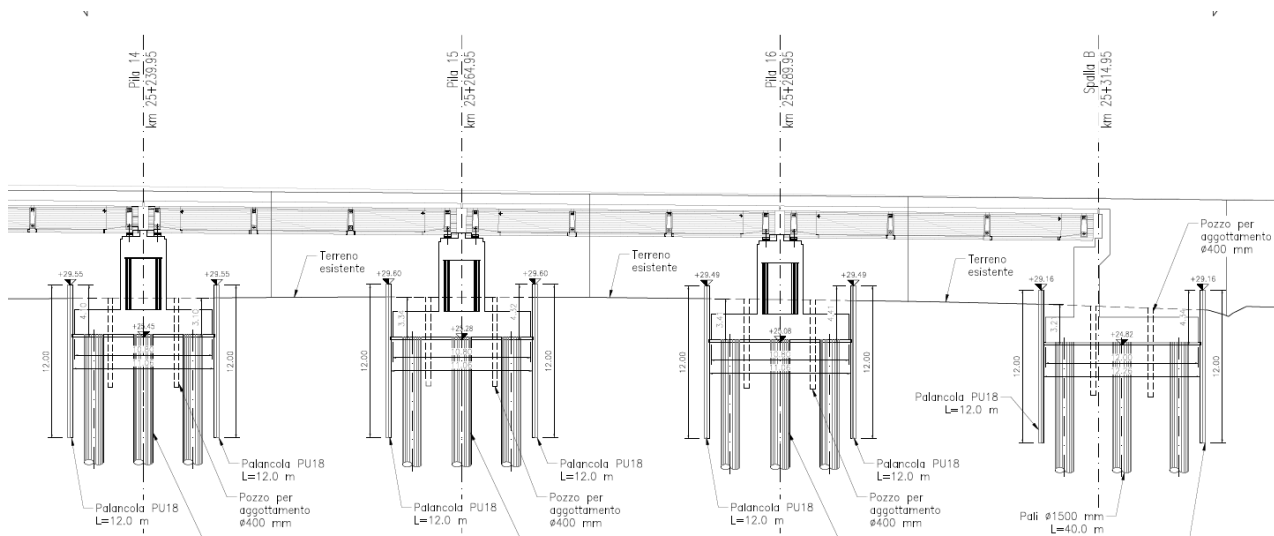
Sezione longitudinale da P14 a spalla B
